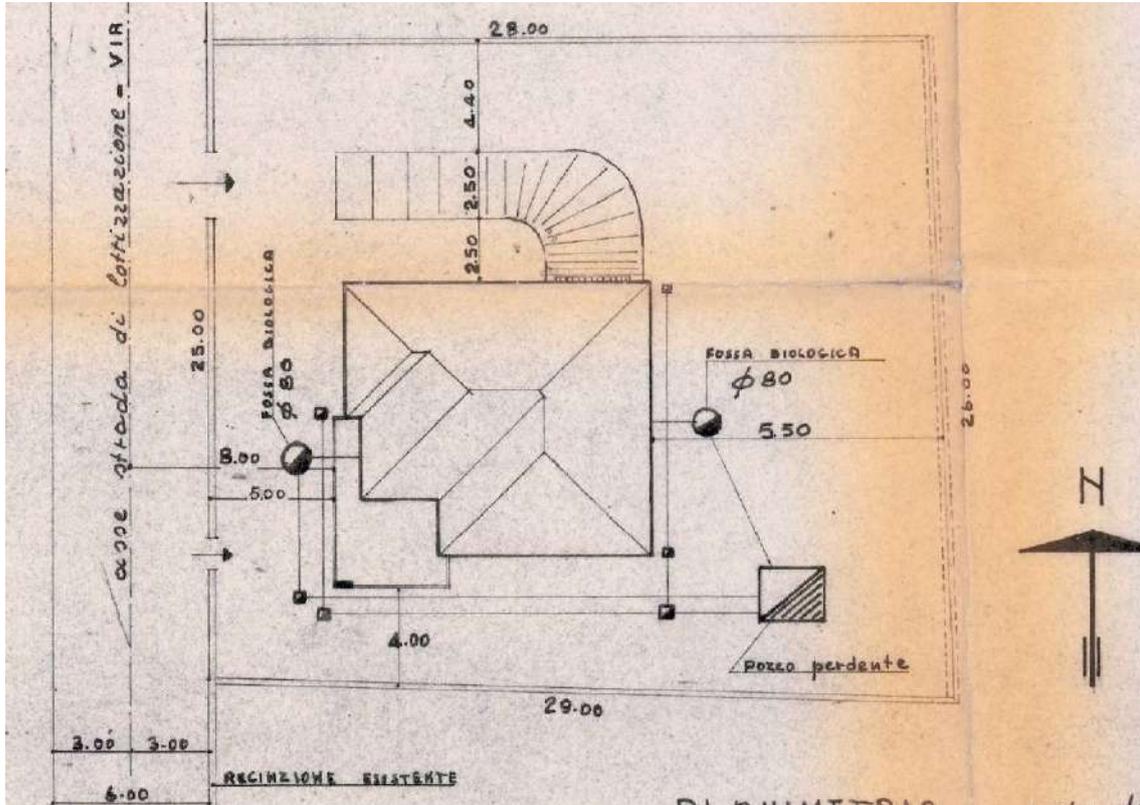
Licenza di Costruzione n. 1289 del 04.03.1968 – planimetria di progetto
